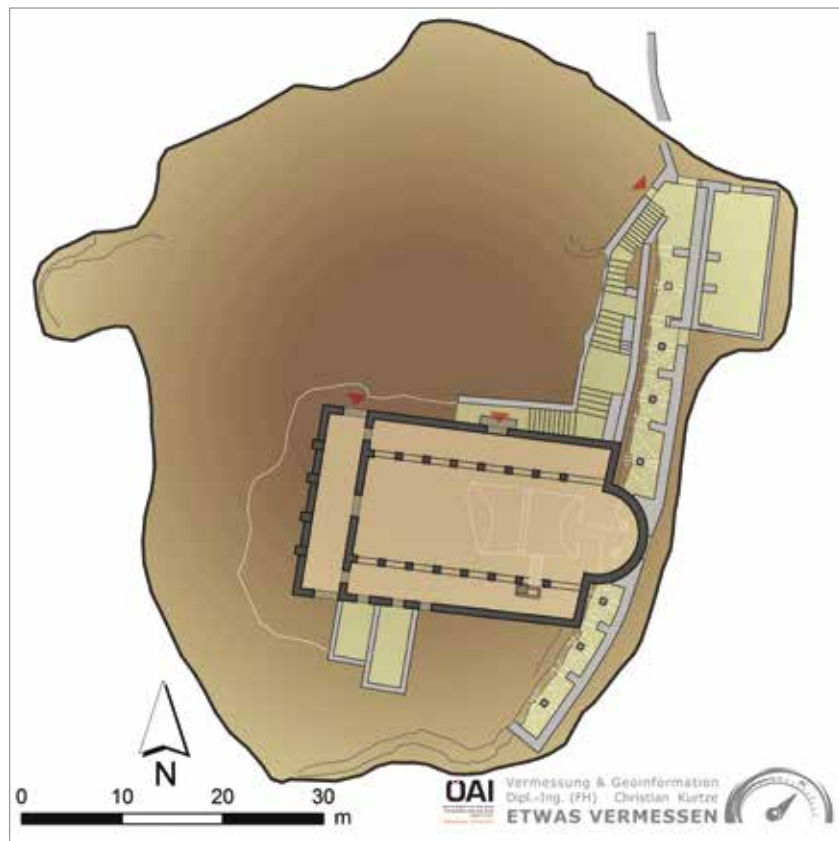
Grundrissplan der spätantiken Gebäude auf dem Kumtepe mit einer schematischen Rekonstruktion des Kirchengrundrisses
